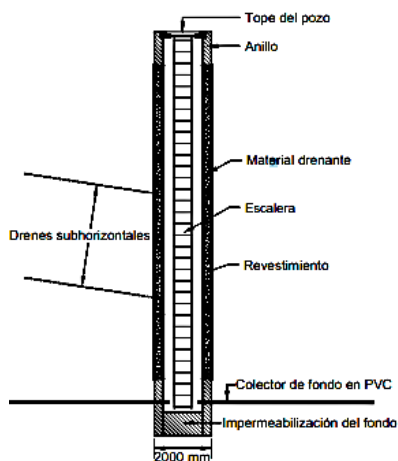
Pozos verticales de drenaje con subdrenes de penetración en el terraplén de una carretera
